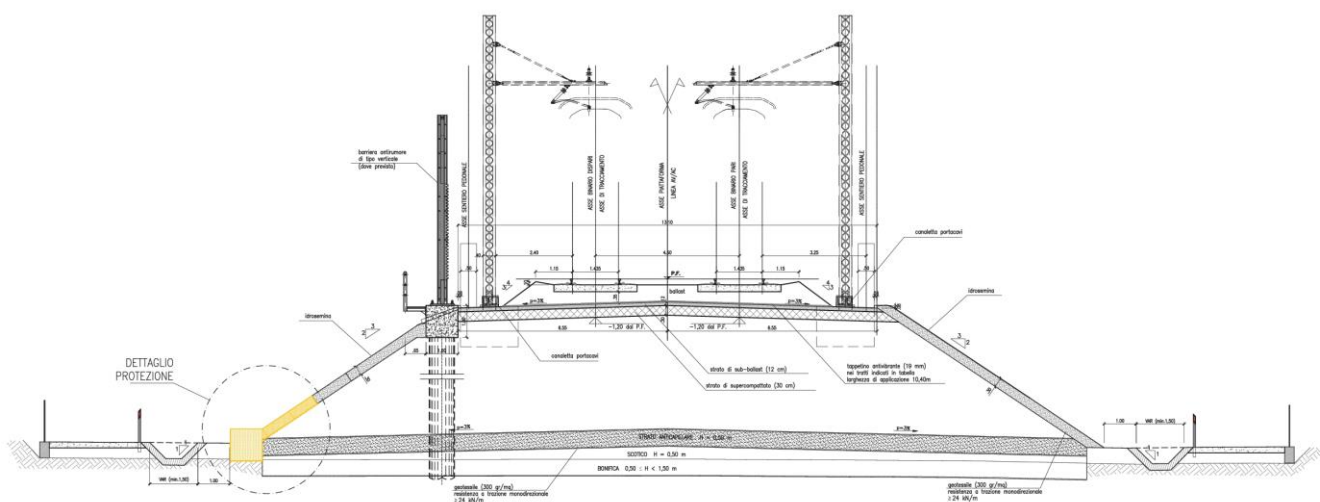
Sezione tipologica di rivestimento al piede del rilevato ferroviario
